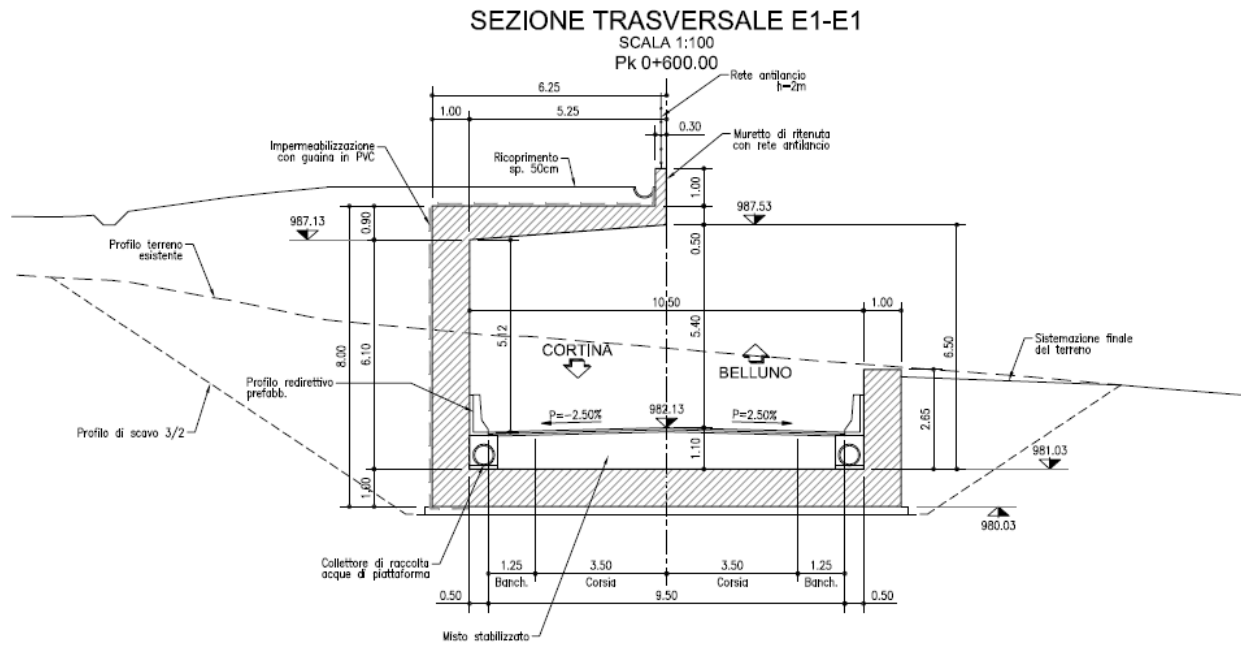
Sezione tipica delle gallerie con mezza copertura e muretto sovrastato da rete antilancio
